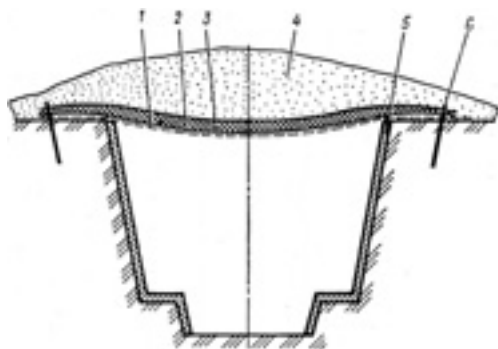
Противорадиационное укрытие из сетки: 1 – сетка; 2 – полиэтиленовая пленка (брезент); 3 – утепляющий слой; 4 – грунт; 5 – одежда кругостей; 6 – анкер.
